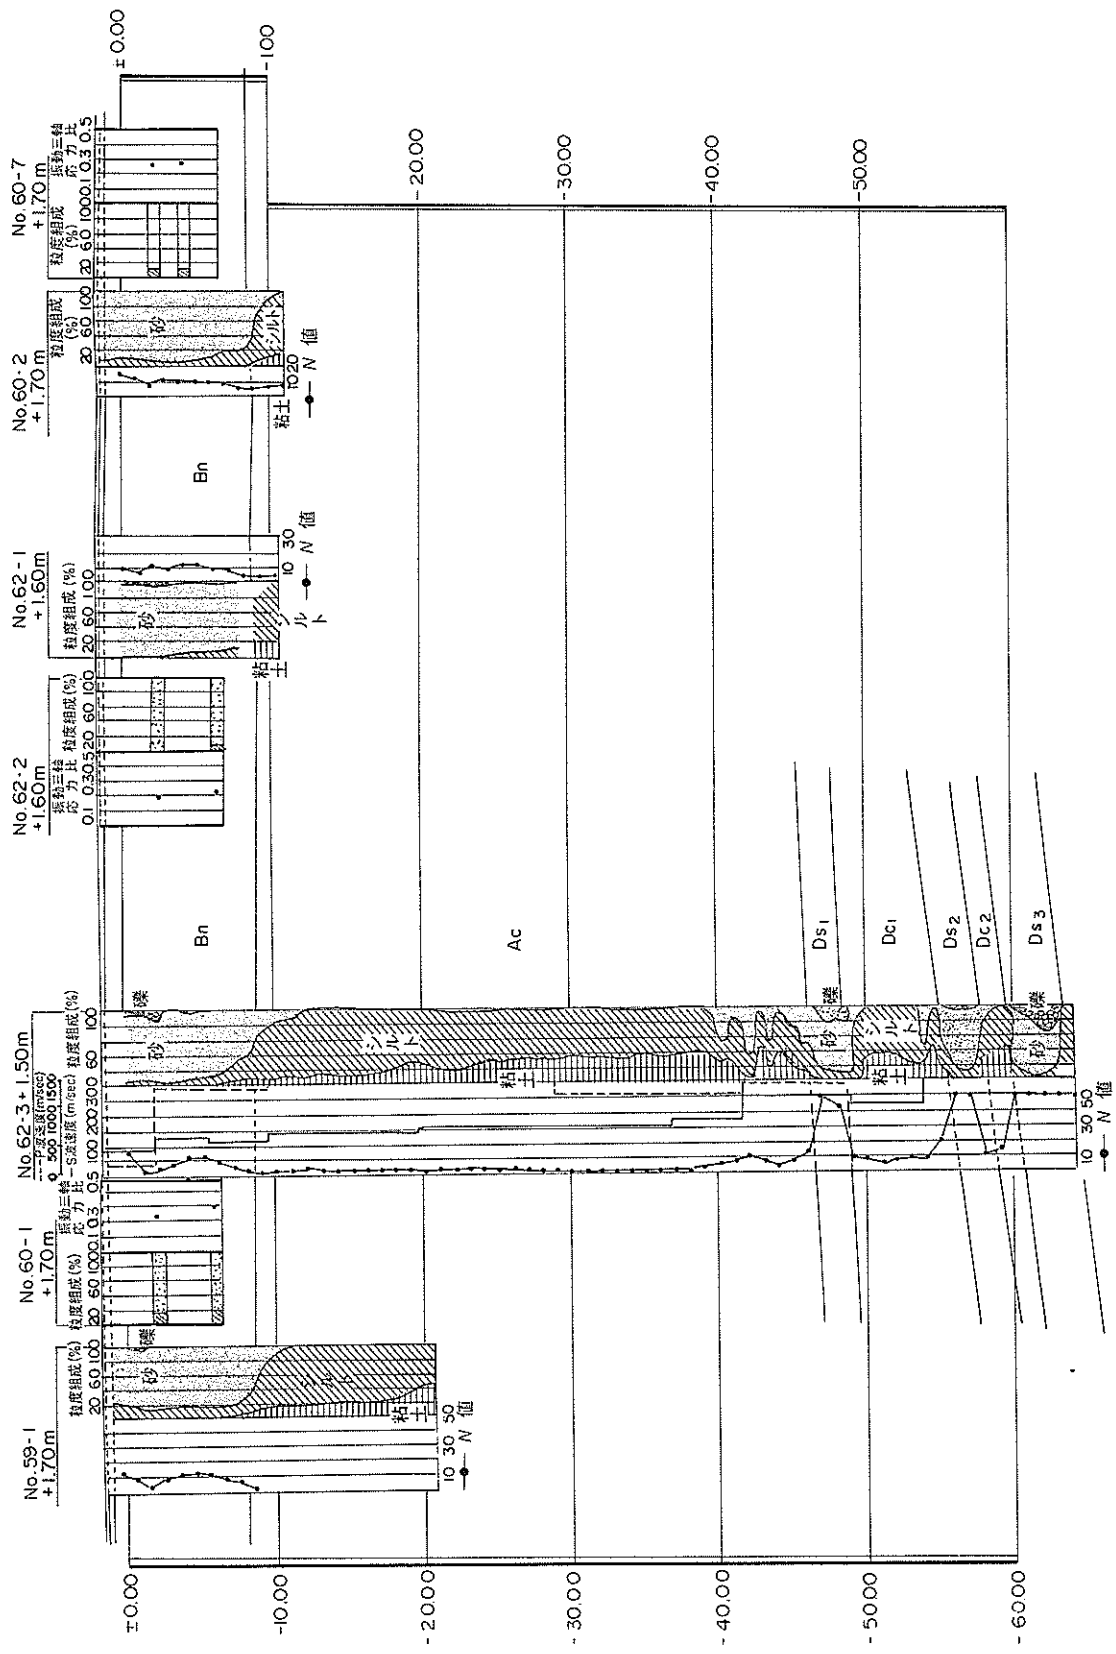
外港昭和北2号岸壁① 地層断面图
